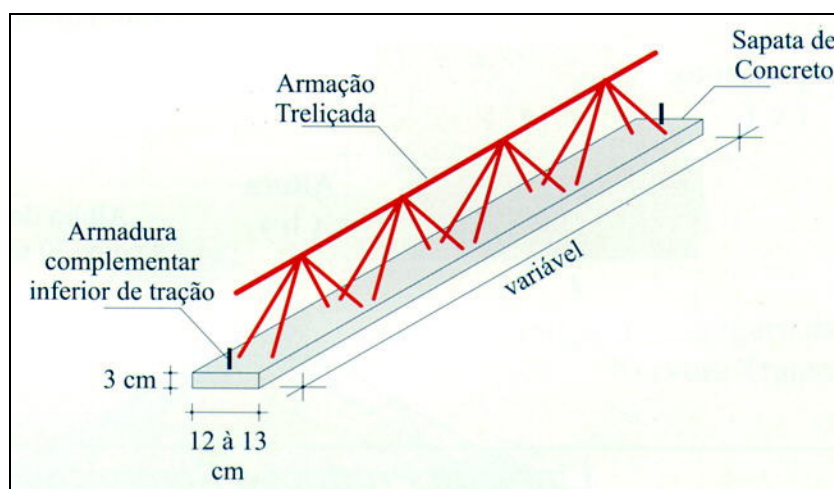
Nervura da laje treliça (FAULIM, 1998).
